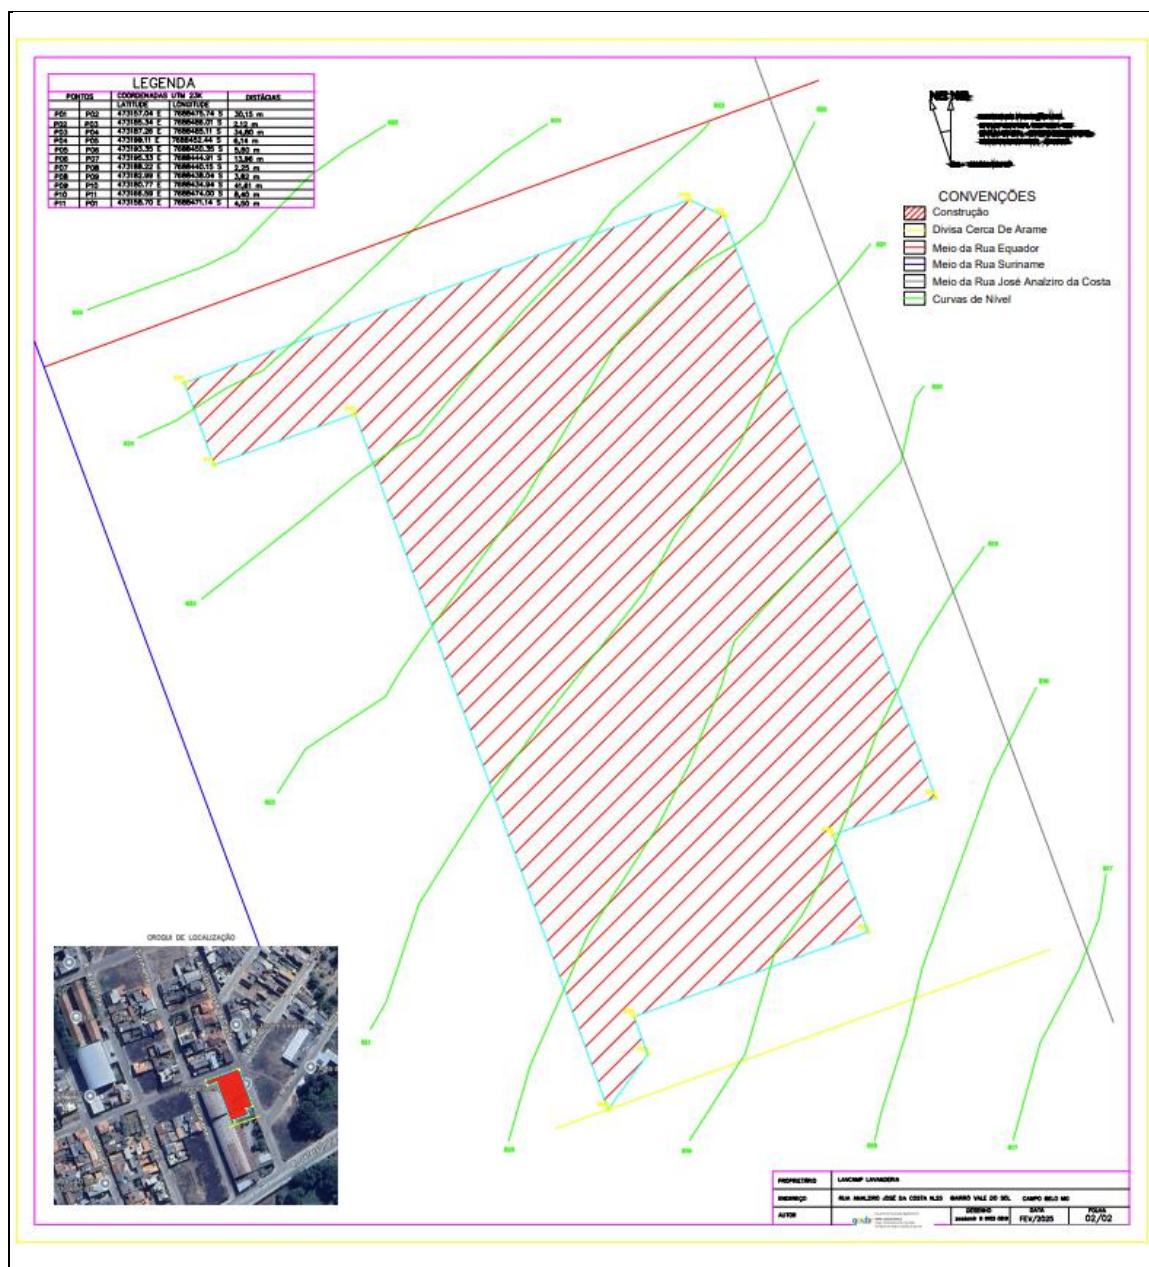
Planta de uso e ocupação do empreendimento. Fonte: SLA
